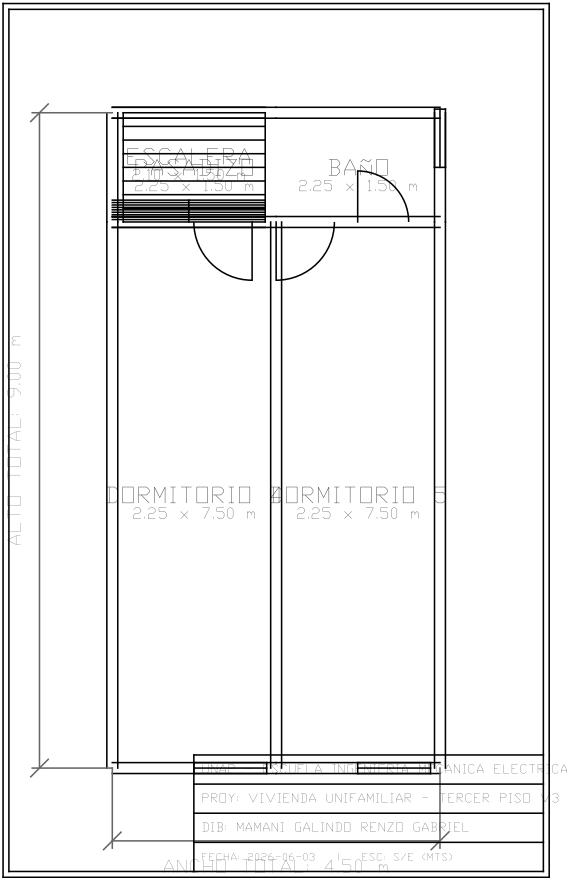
Plano de Distribución Arquitectónica - Tercer Piso
